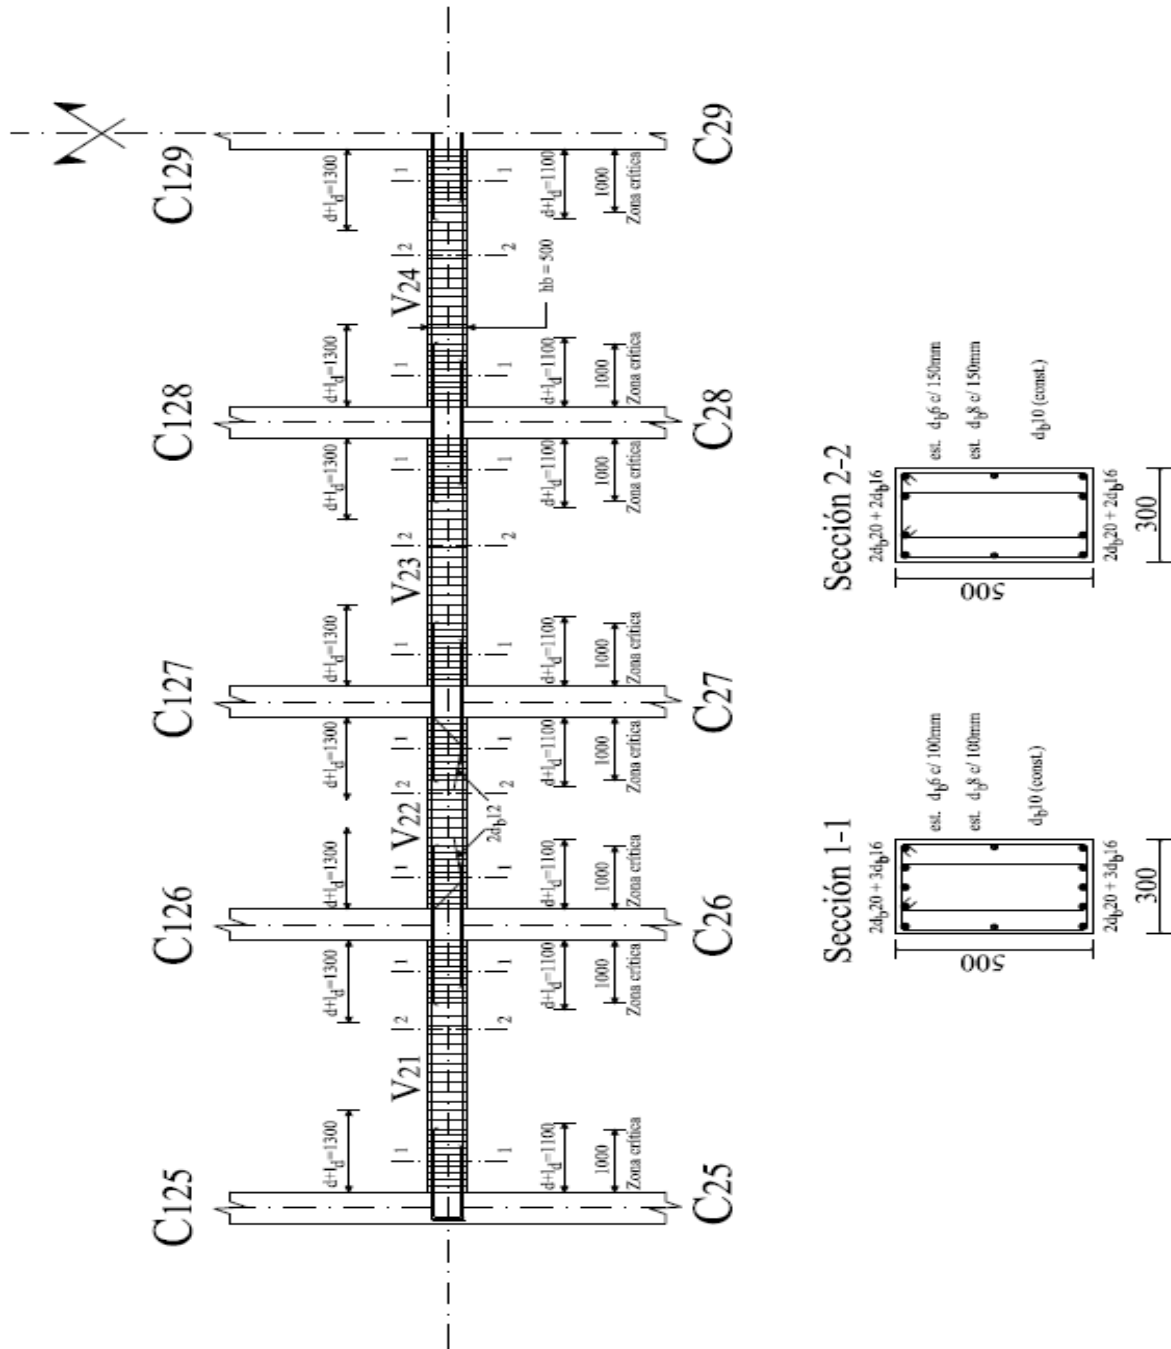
DETALLE DE ARMADO DE VIGAS (Vigas Nivel 1 – Pórtico X5); (mm)
